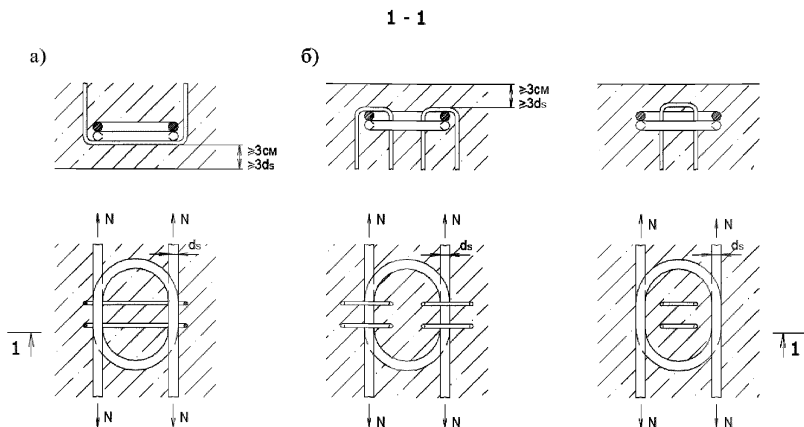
Усиления стыков внахлестку с петлями с помощью утолщения защитного слоя бетона и установки поперечной арматуры (шпилек):
